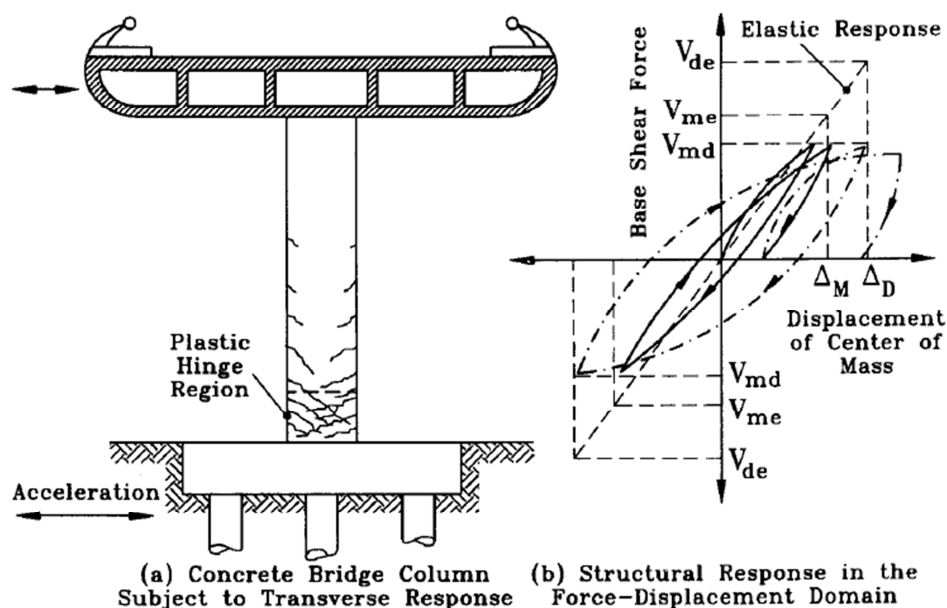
Respuesta dúctil de un puente de hormigón (Tomado de Priestley, Seible y Calvi, 1996)
